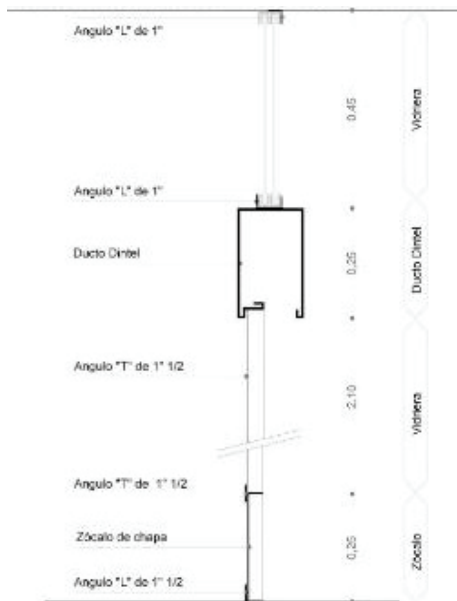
Detalle de sistema de cierre interiores y carpintería
